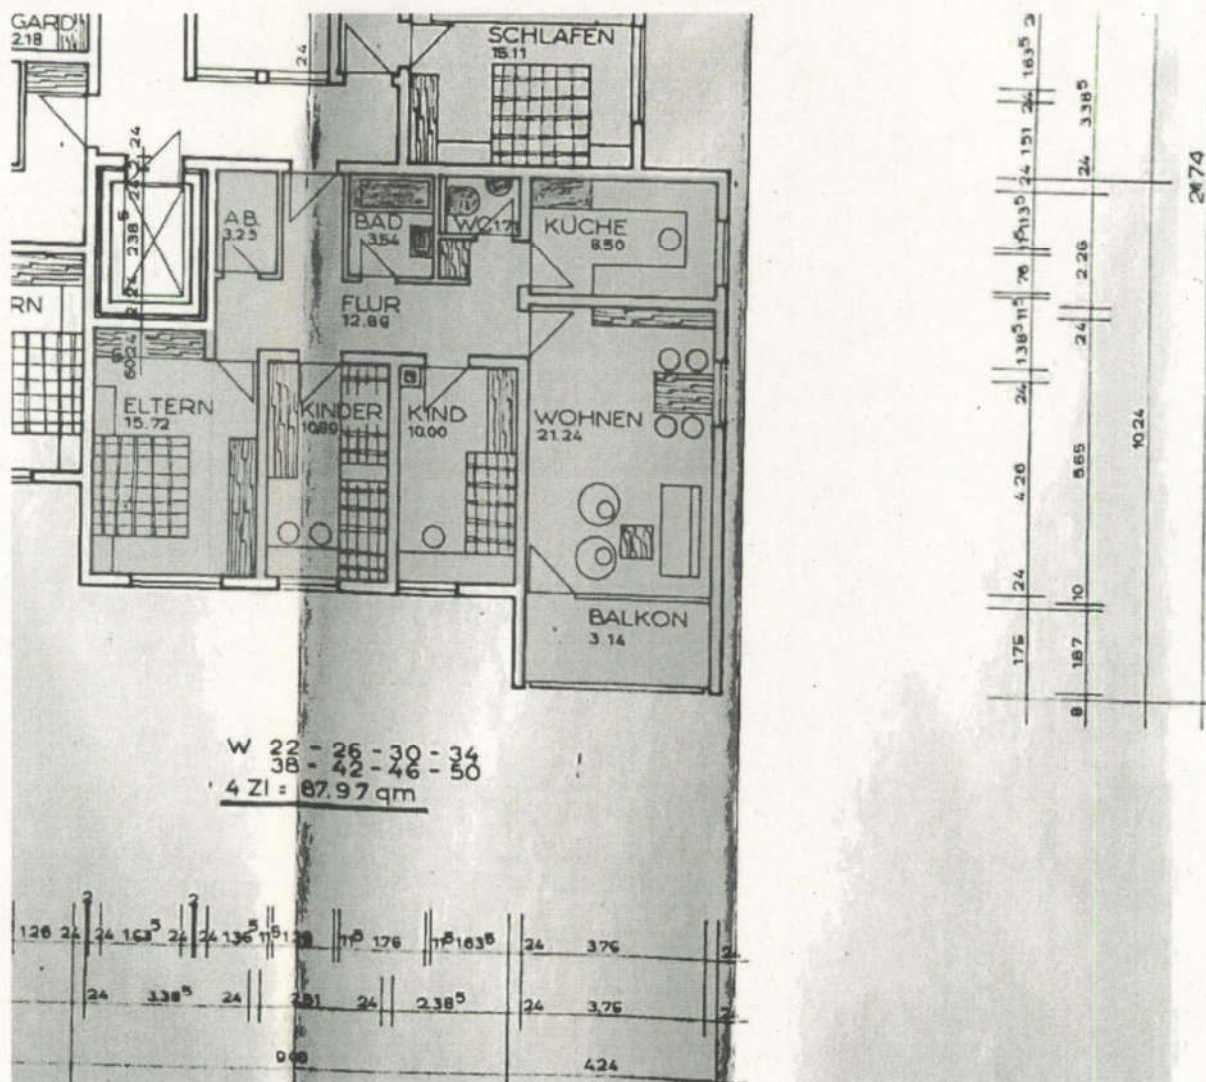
Grundriss Wohnung Nr. 38
